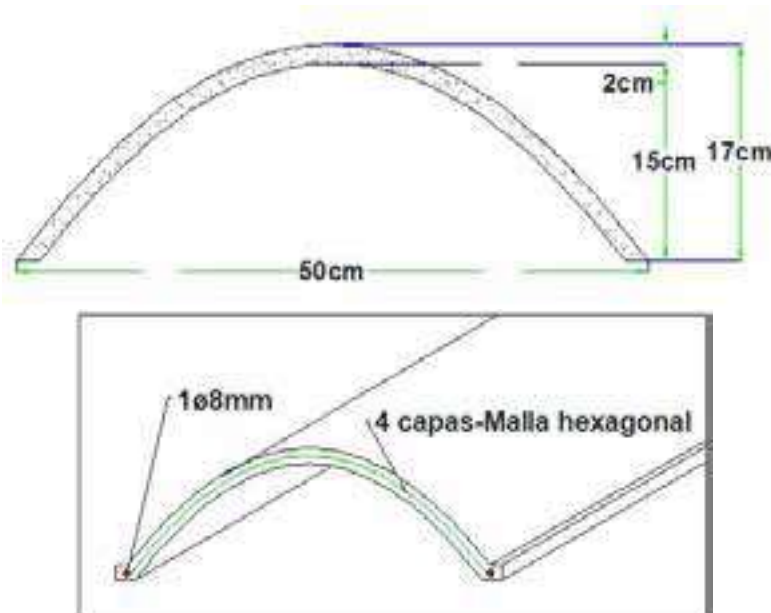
Sección transversal de la prelosa prefabricada de ferrocemento (PPF) y su armado. Se diseñó de conformidad con la NEC-15.
